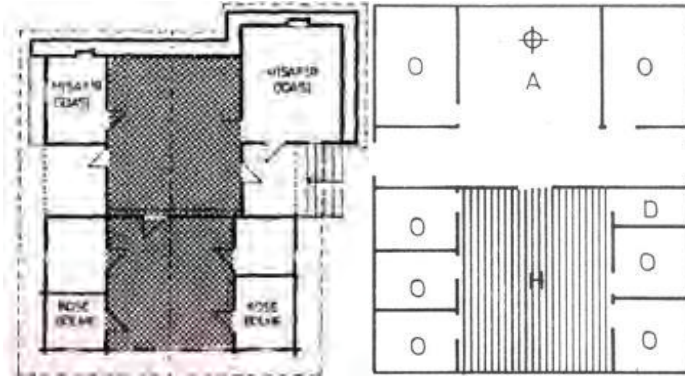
Salonlu plan tipi (Sümerkan, 1990)
